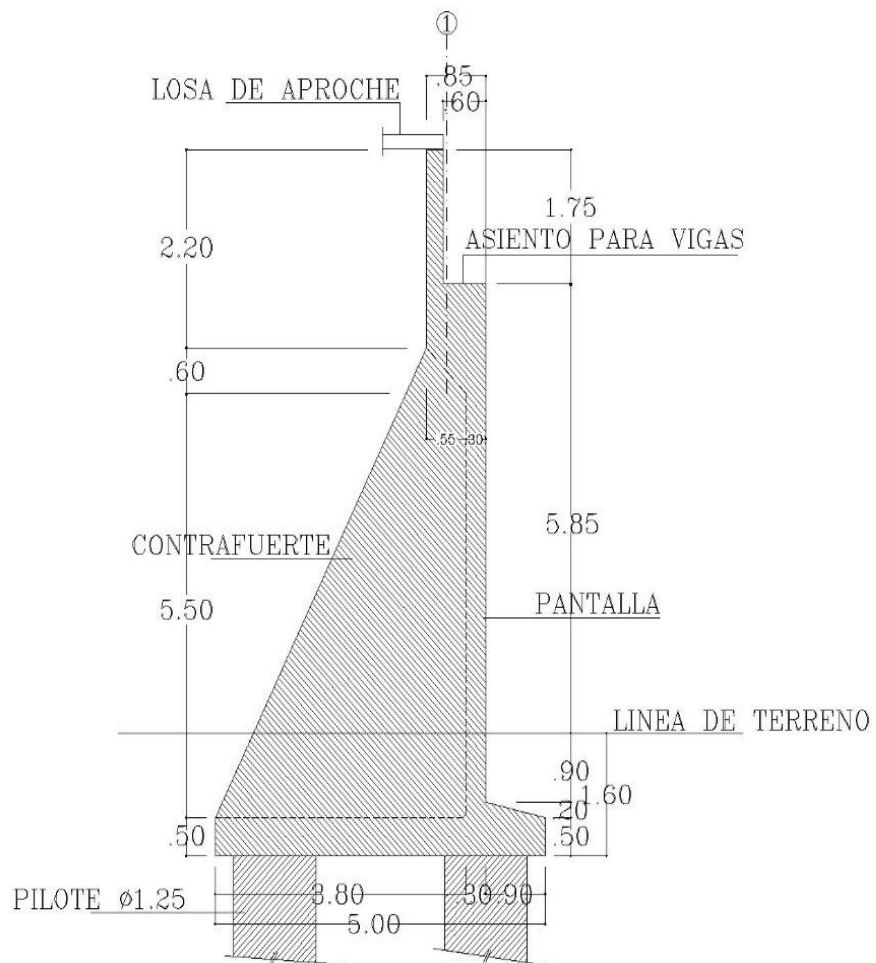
Sección típica de estribo (información suministrada para chequeo estructural).
